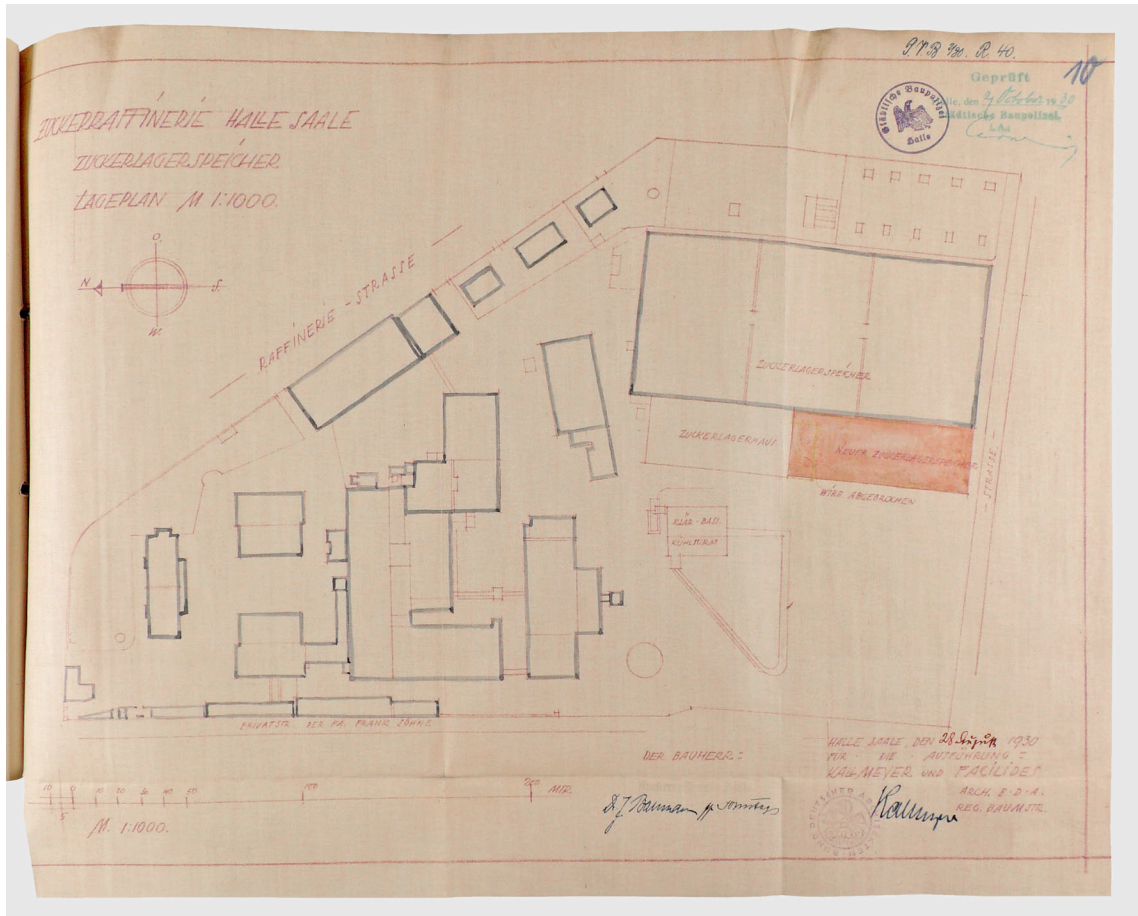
Zuckerlagerspeicher in der Raffineriestraße 28 in Halle, Lageplan, datiert 28. August 1930.
